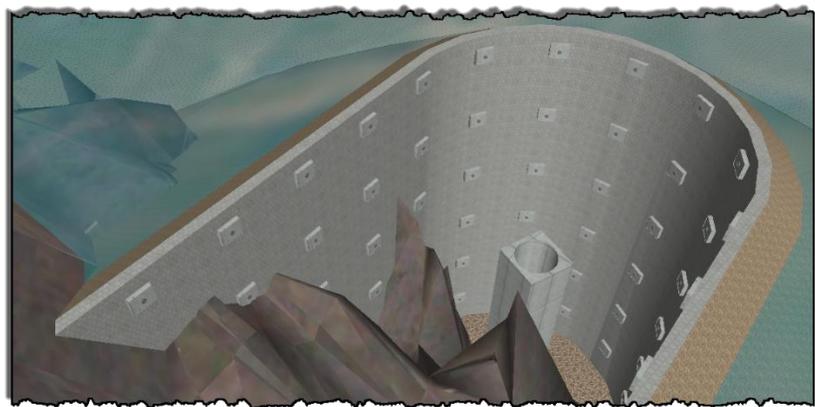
Vista de perspectiva para aislar la estructura de la obra de toma.
